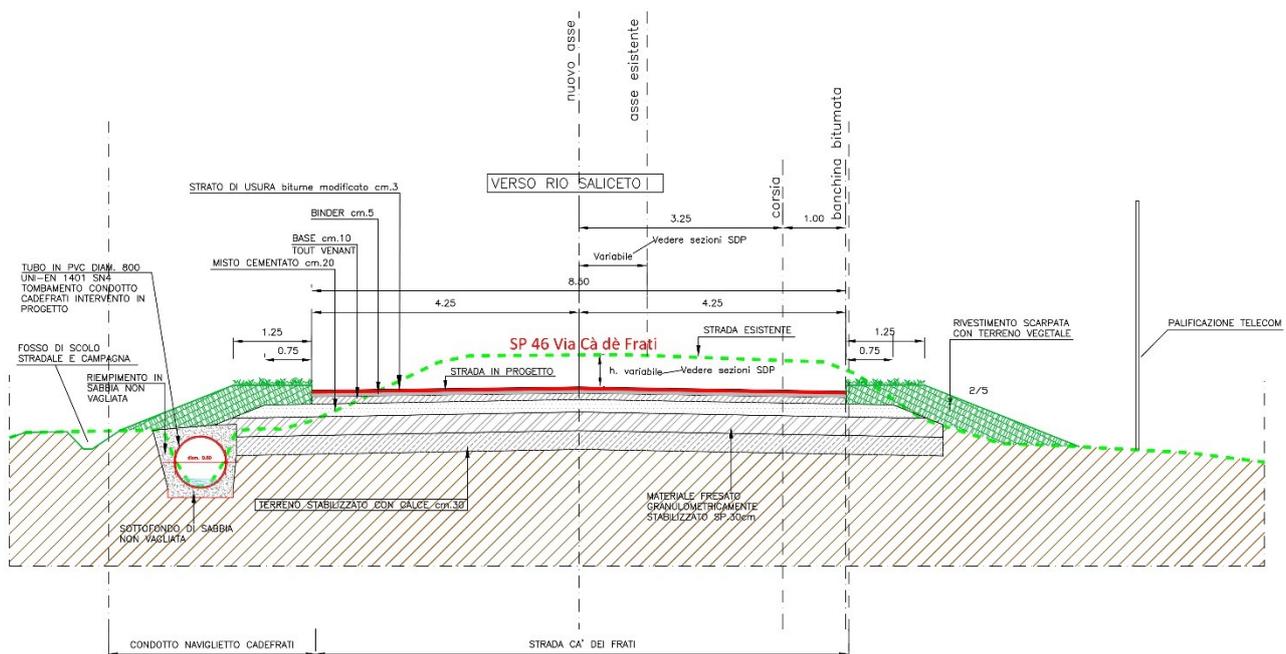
Sezione tipologica di progetto (lato Rolo)
